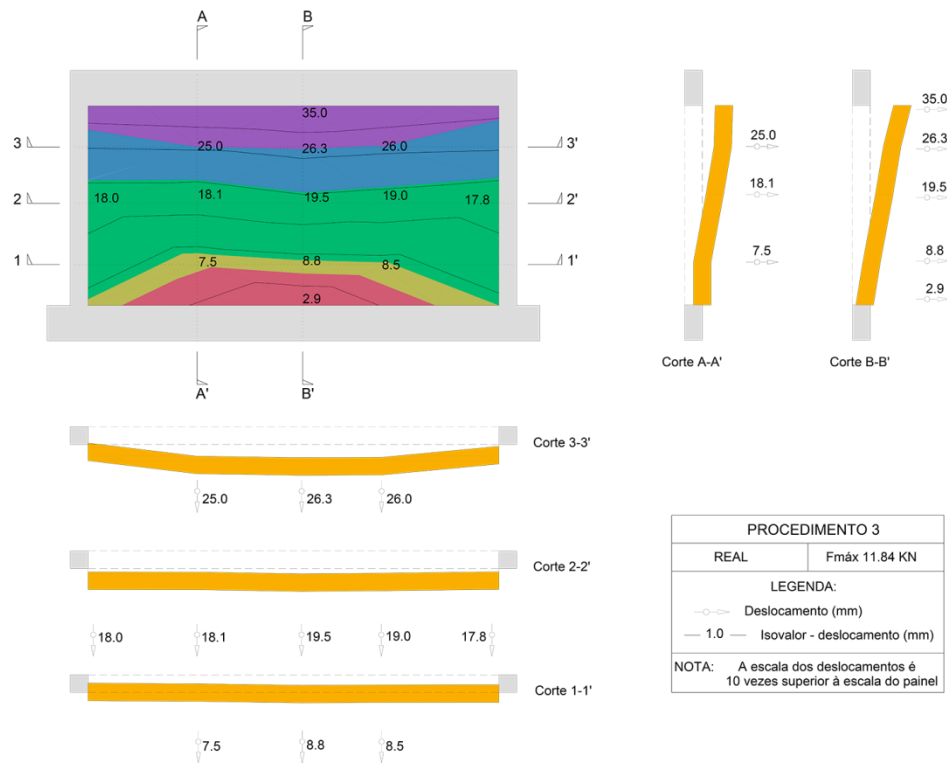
Isovalores da parede ensaiada - Procedimento 3. Ensaio fora do plano, Wall_REF_01.
